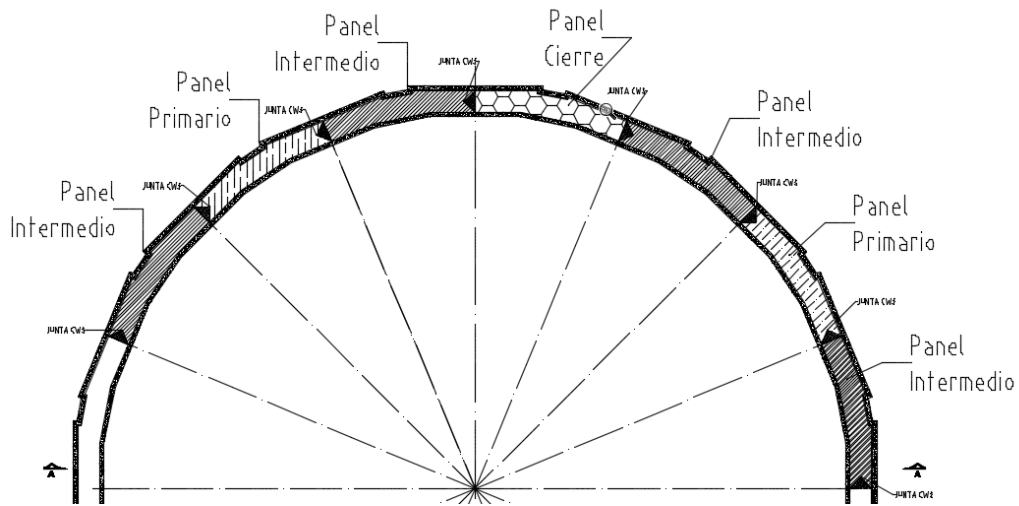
Tipos de paneles de excavación.⁴⁷
